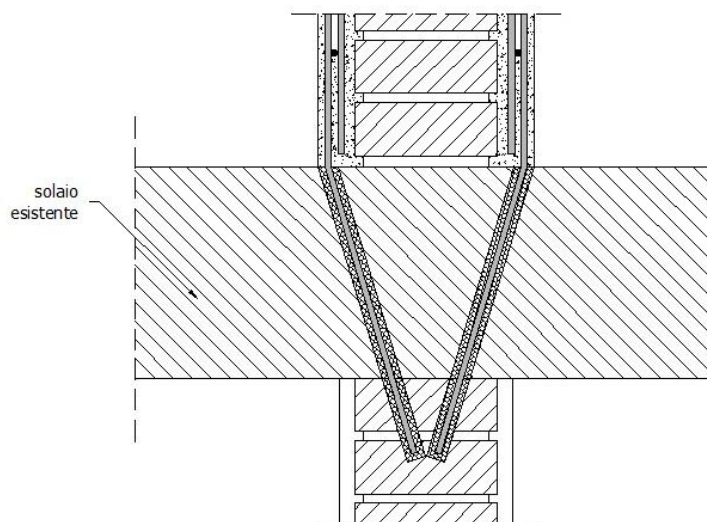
Collegamento dell'intonaco armato al solaio esistente
